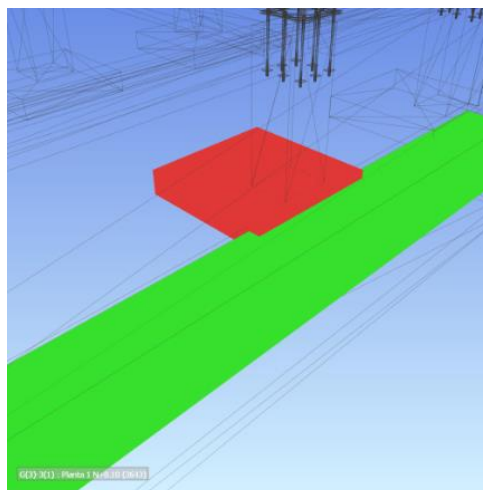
Interferencia vigas fundación vs muro de contención.
